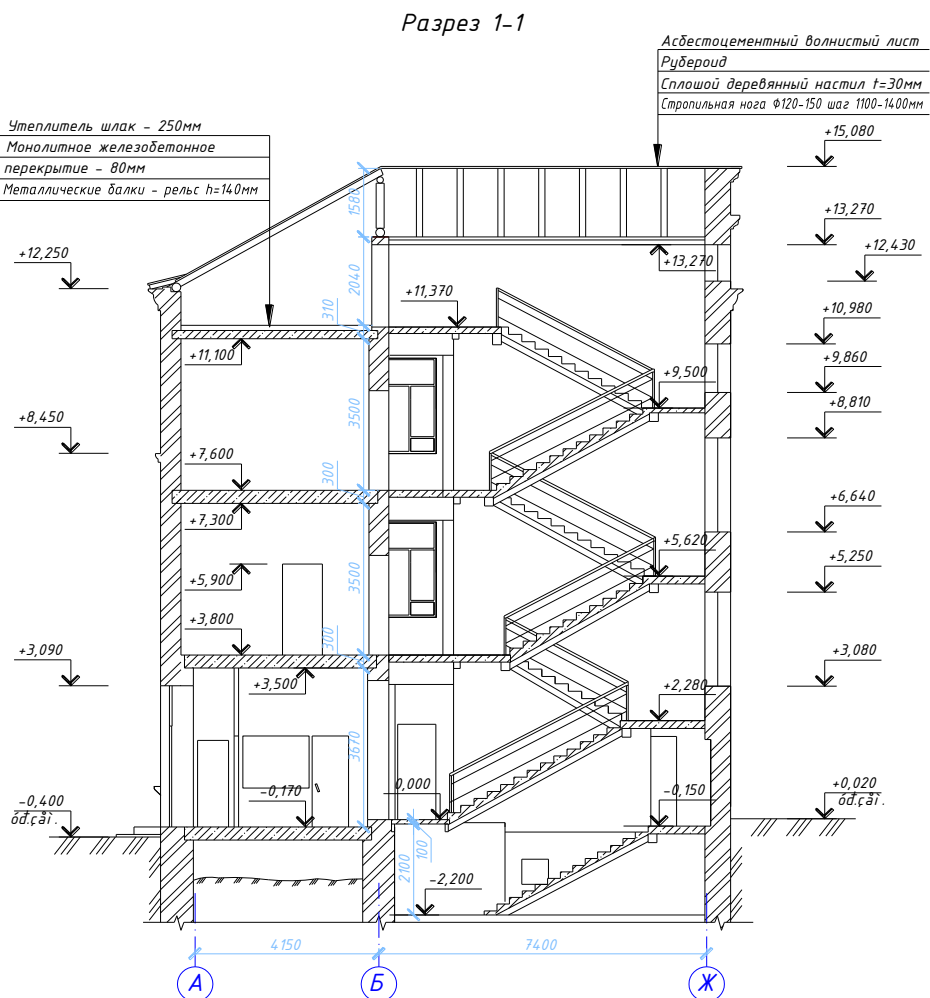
Разрез 3-этажного здания в г. Ростов-на-Дону
